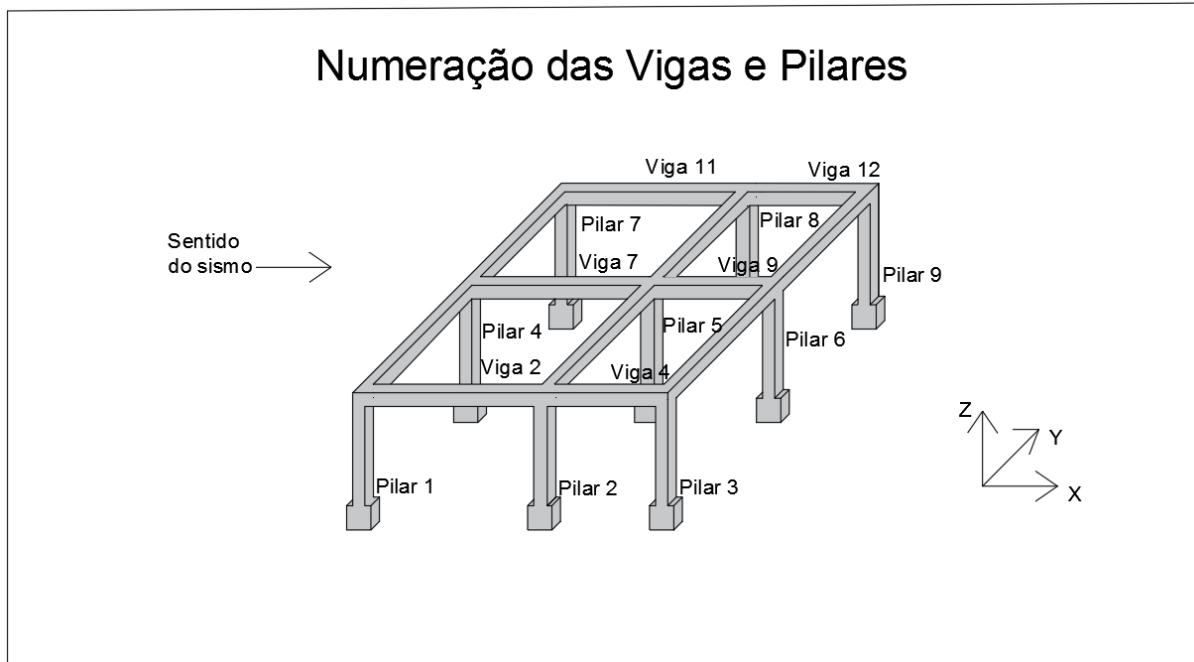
Numeração das vigas e pilares de cada piso.
